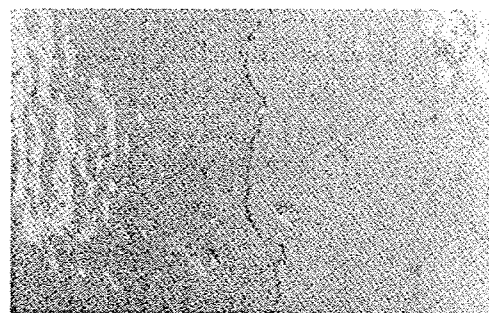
上面ひび割れ(打設後1時間)
